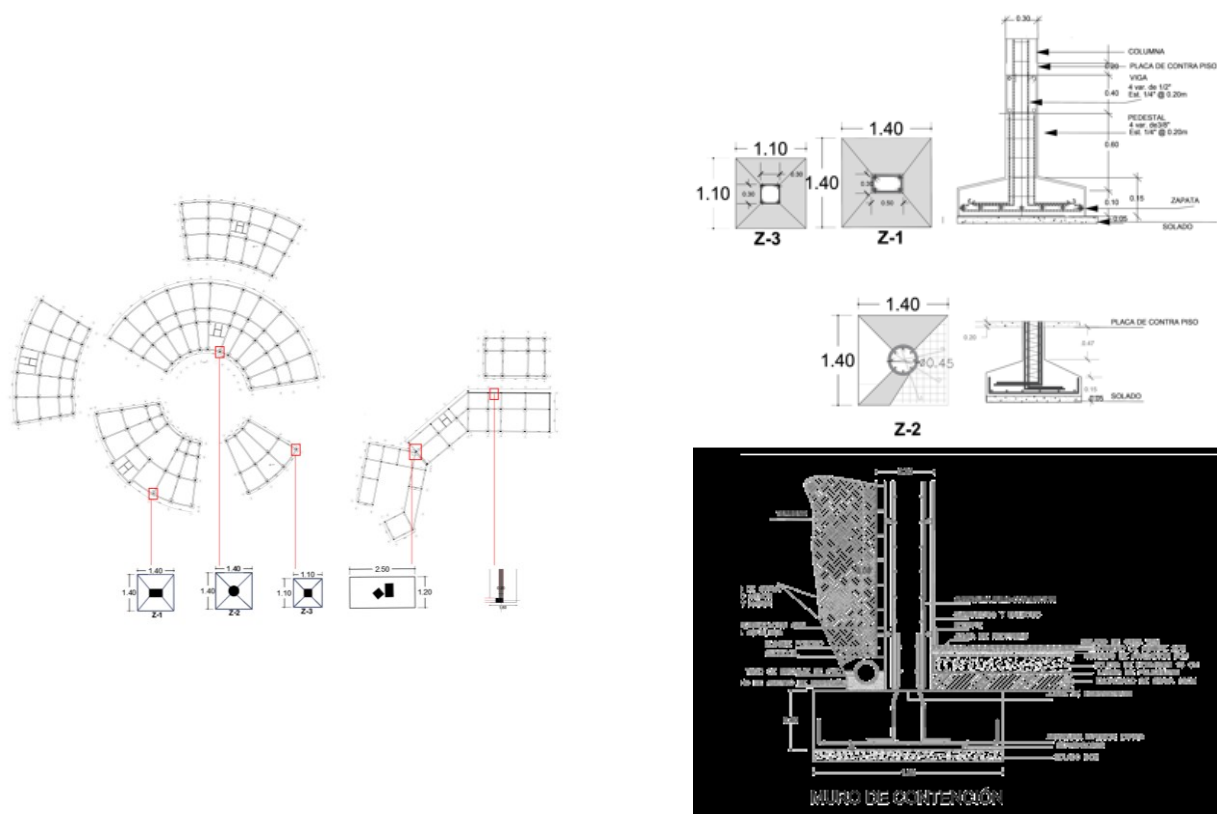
Distribución de la cimentación y detalles constructivos.
